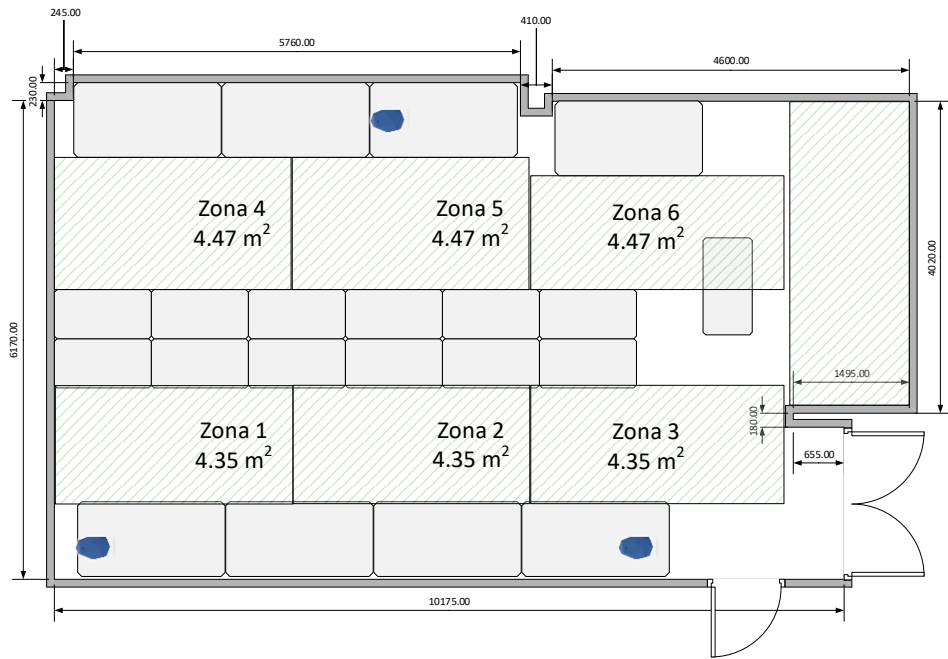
Área de trabajo con 3 beacons ubicados sobre los módulos.
